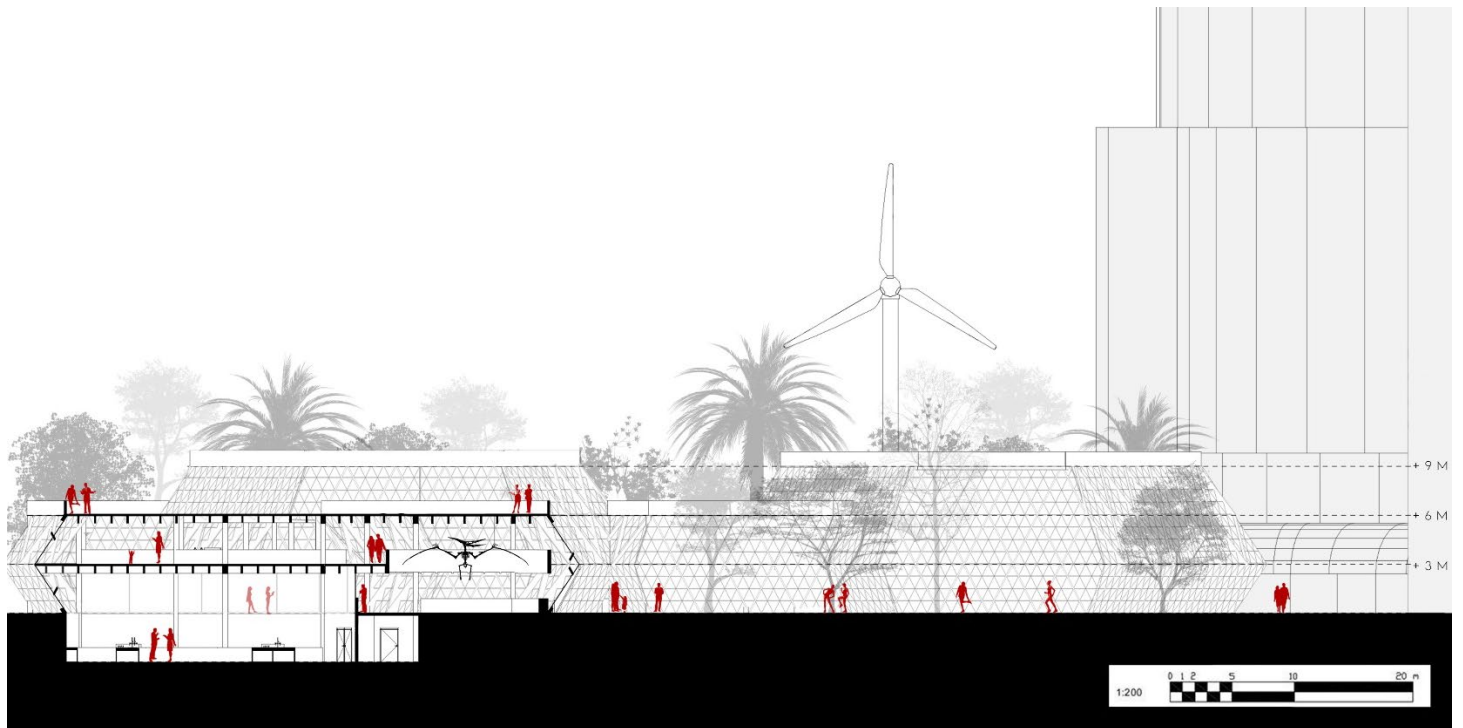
Corte longitudinal D-D'. Elaboración propia.
